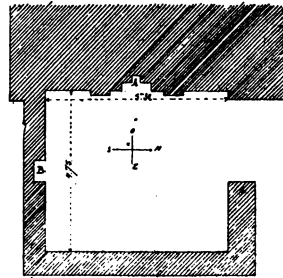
PLAN DU MASTABA DE KAÂPIROU
